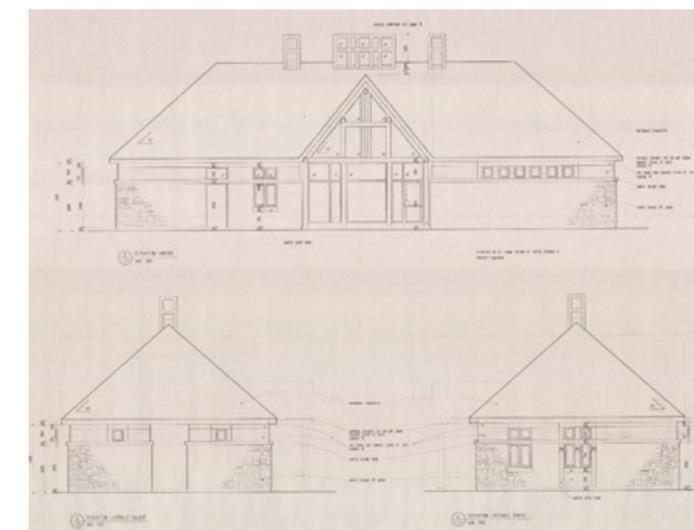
Élévation des façades latérales et arrière du pavillon D39, 1991
